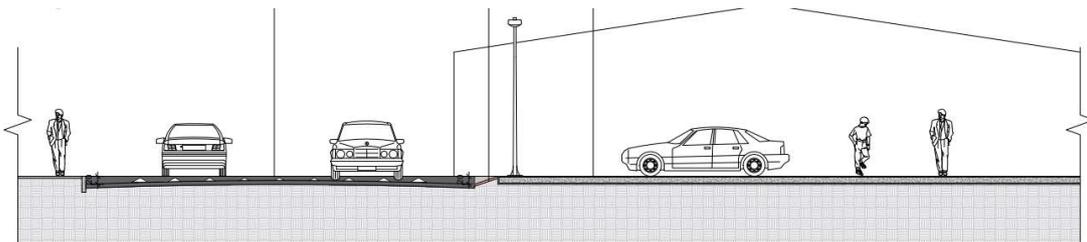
Corte do trecho 03. Fonte: Elaborado pelo autor.
